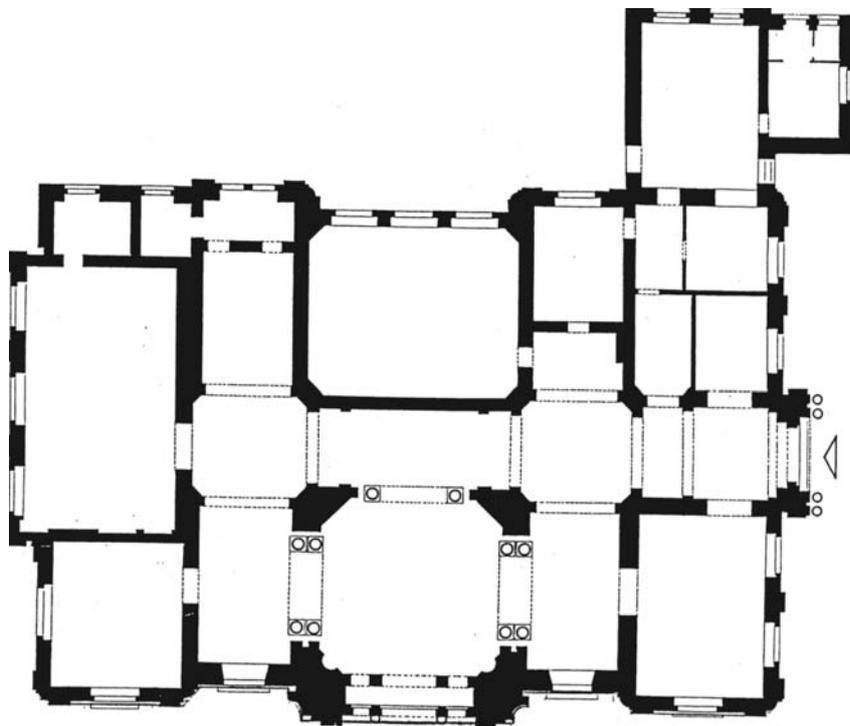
Schloss Von der Heydt, Rekonstruierter Grundriss Erdgeschoss, 1972
